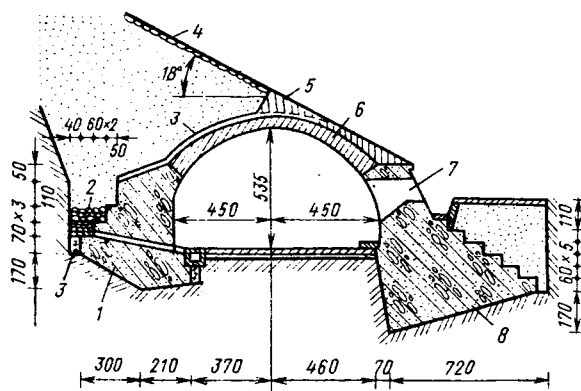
Поперечный разрез галереи «Белая речка»: 1 — опора верховая; 2 — дренаж застенный; 3 — глина мятая; 4 — мощение каменное; 5 — слой бетонный защитный; 6 — свод железобетонный; 7 — проем для освещения; 8 — опора низовая
